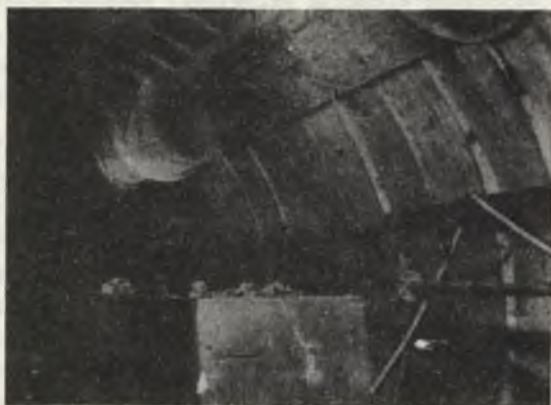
Widok pojedynczego elementu żelbetowej obudowy pierścieniowej
